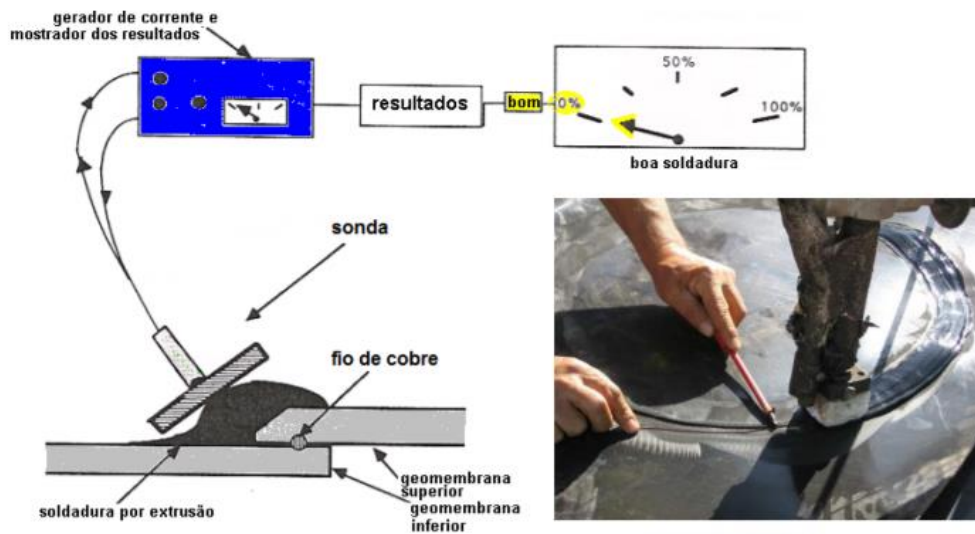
ENSAIO DE SPARKTEST [1]
